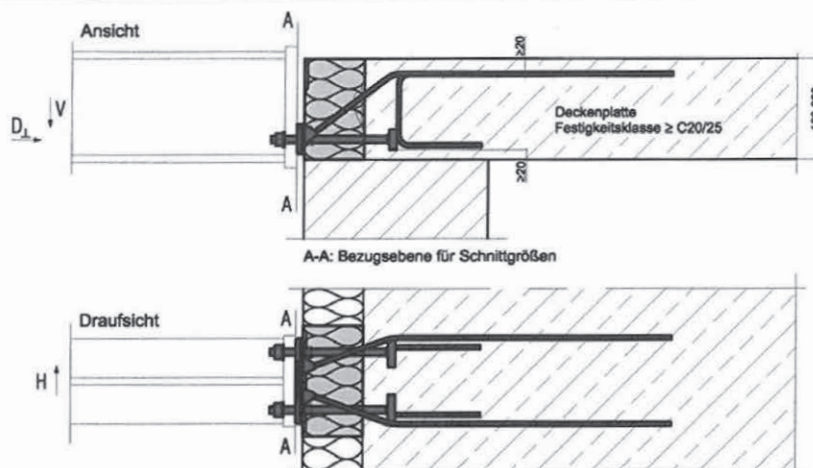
und 76: Schöck Isokorb® Typ QSXT8, QSXT10 und QSXT12 Schnittgrößendefinition
